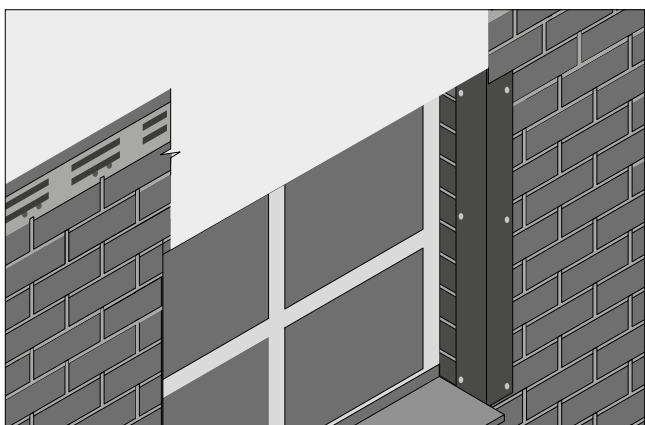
Монтаж бокового наличника (верхний край заходит под фасадную плитку)
